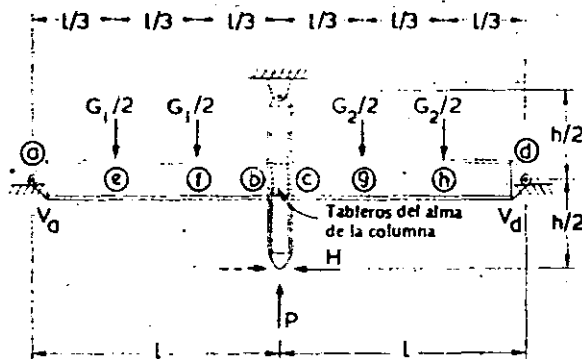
Ensayo de una subestructura (según Krawinkler y colaboradores^{4,41}).
